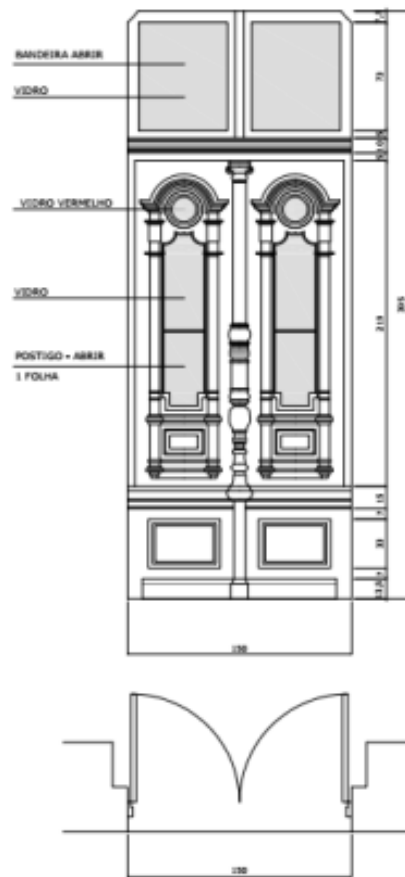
Detalhamentos do projeto de restauração – Ferragens Hauer
